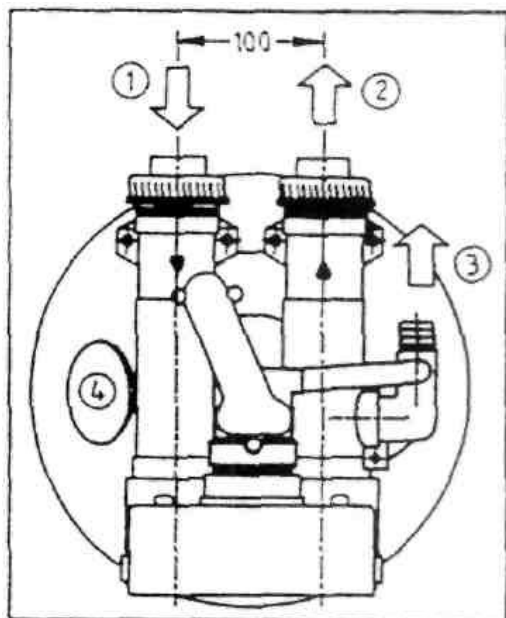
Vue de dessus JEF-EM 2 K-A
